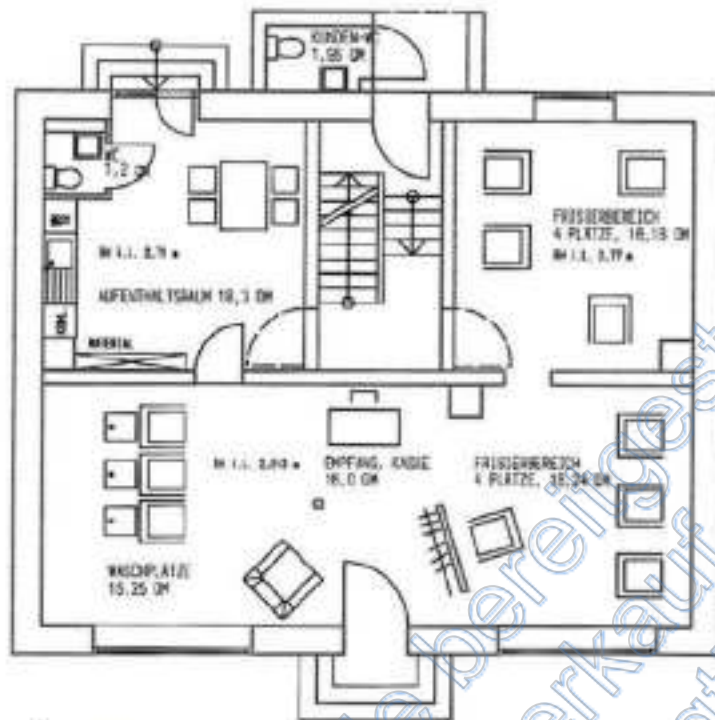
Grundriss Erdgeschoss aus einem Verkaufsprospekt, Quelle: der Antragsteller.
